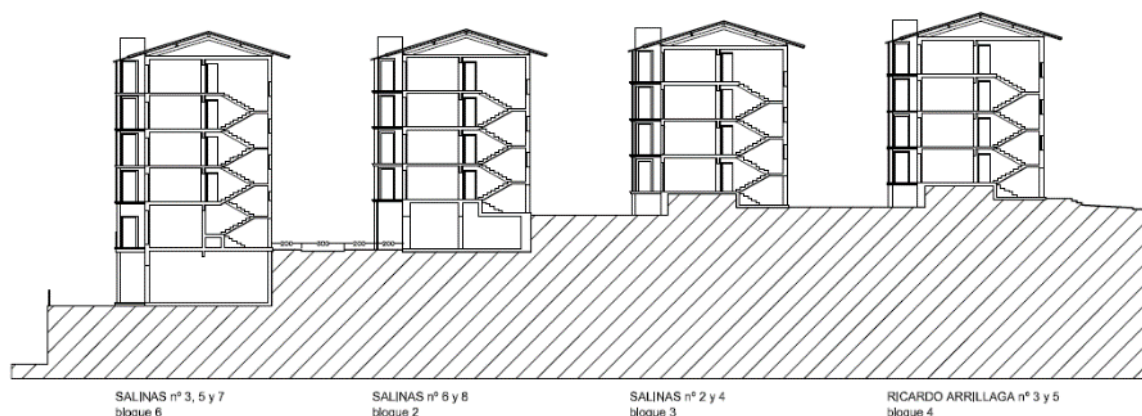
Secciones generales de los bloques residenciales ubicados en Salinas, tras la ejecución del Plan Especial. Fuente: Plano PRO.08-2 del Plan Especial.
